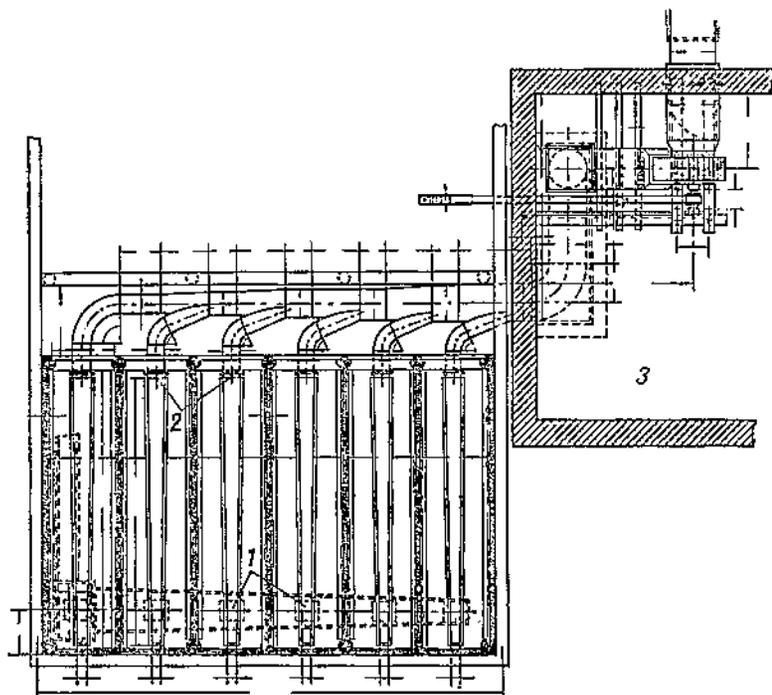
План воздуховодов камерной сушилки льнозавода строительства 1932 г.:
